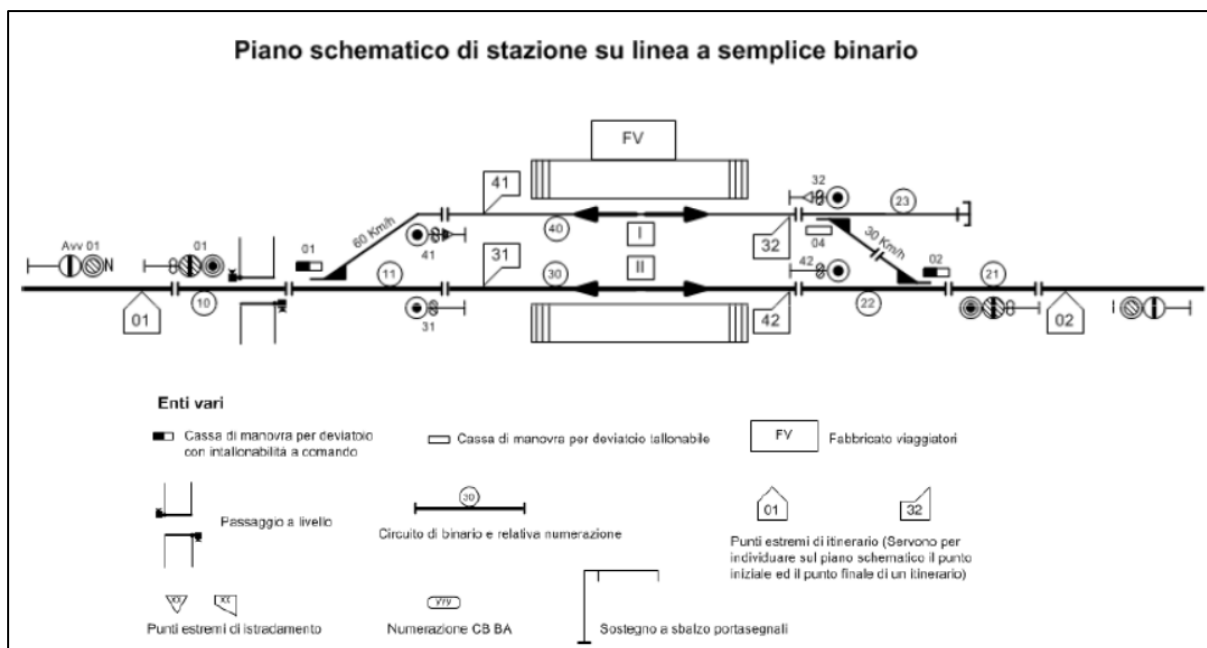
PIANO SCHEMATICO DI STAZIONE
